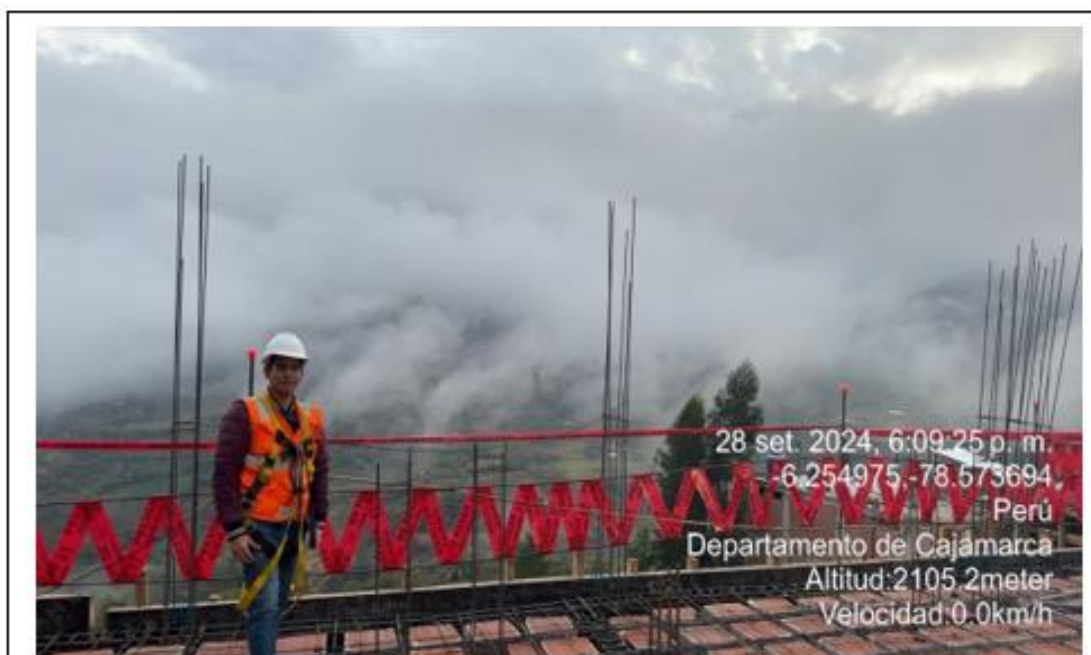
Verificación de losa aligerada previo vaciado de concreto
